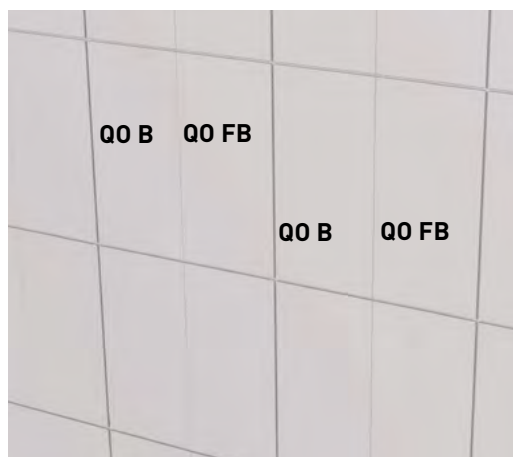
Połączenie elementów QO FB + B – montaż poziomy
